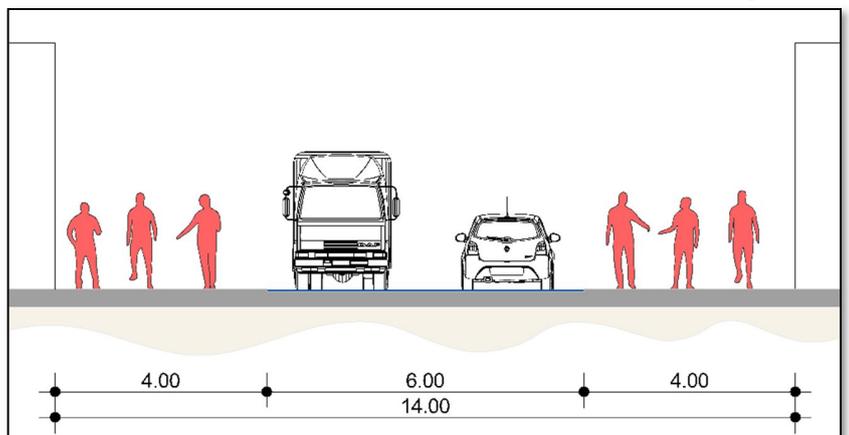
Sección de 0 cero calle, zona 1 de Parramos, Chimaltenango
